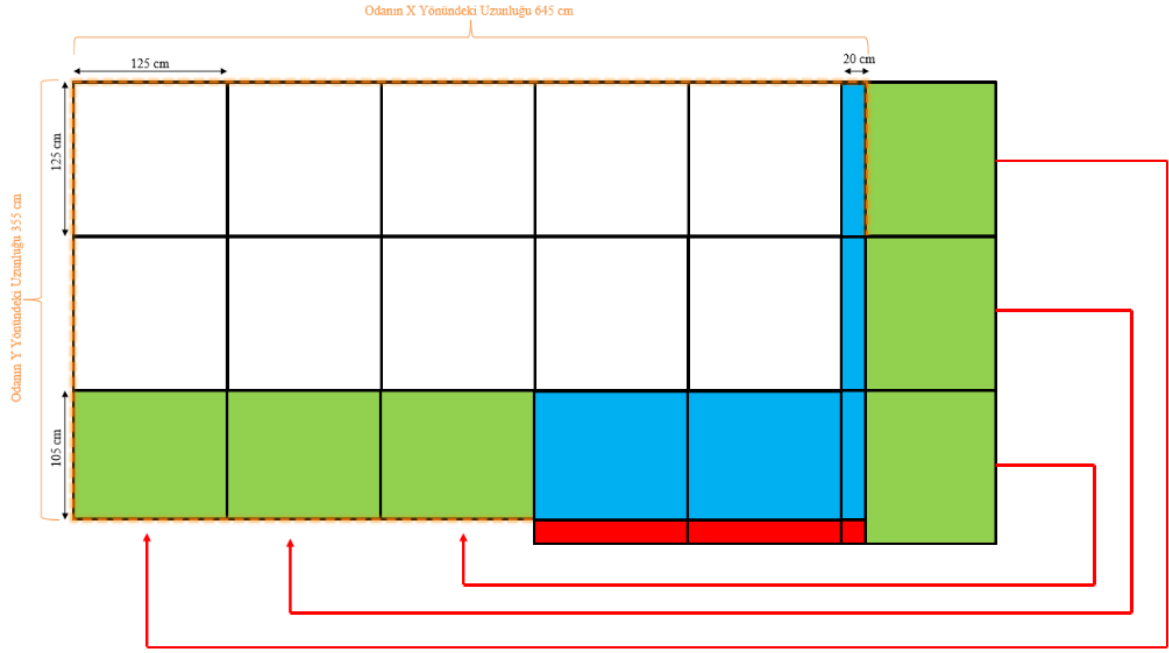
İkinci alternatife göre 125x125 cm boyutlarındaki kalıp malzemesinin 645x355 cm boyutlarındaki odaya yerleştirilmesi
